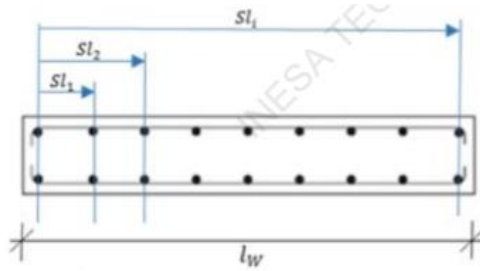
Representación de la separación entre barras longitudinales para el muro estructural
